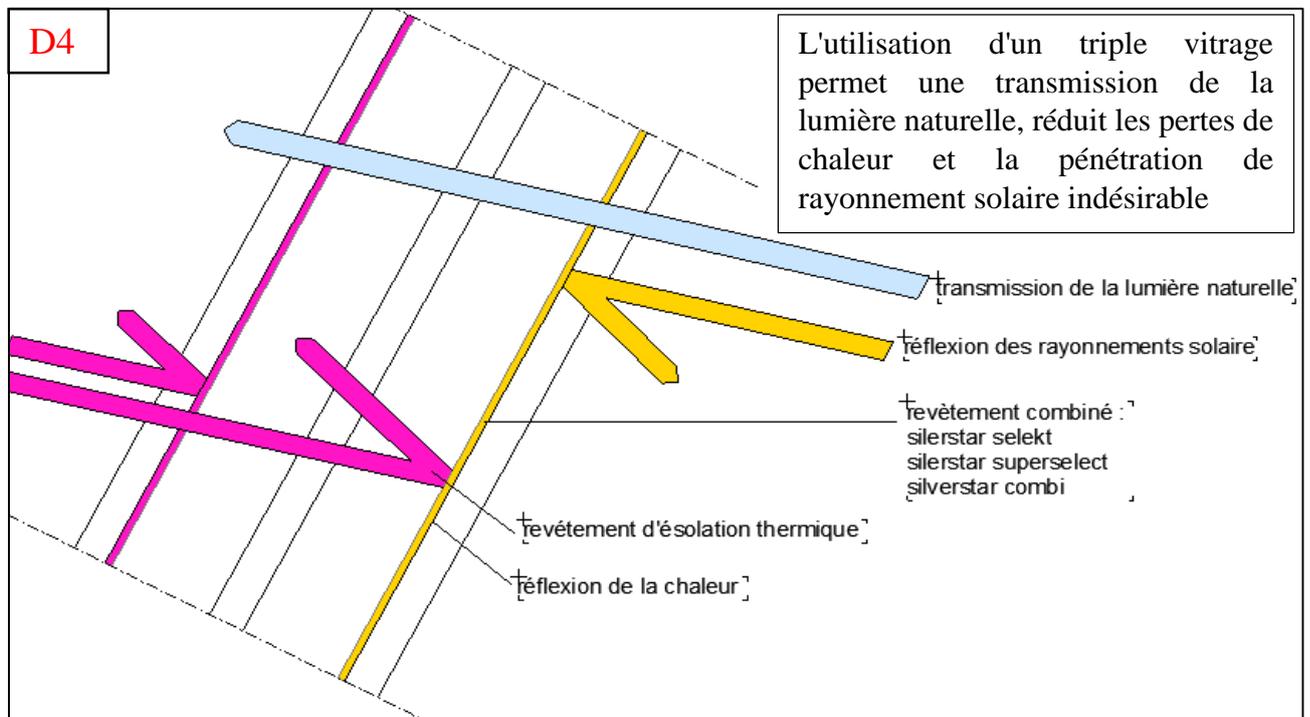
Détail d'un triple vitrage isolant (source : auteur).
